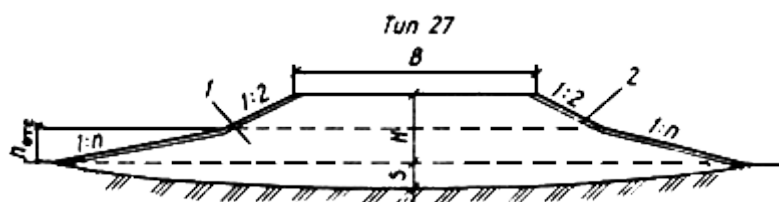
Поперечный профиль насыпи, возводимой способом гидромеханизации: 1 - гидронамывной песок; 2 - укрепление откоса
